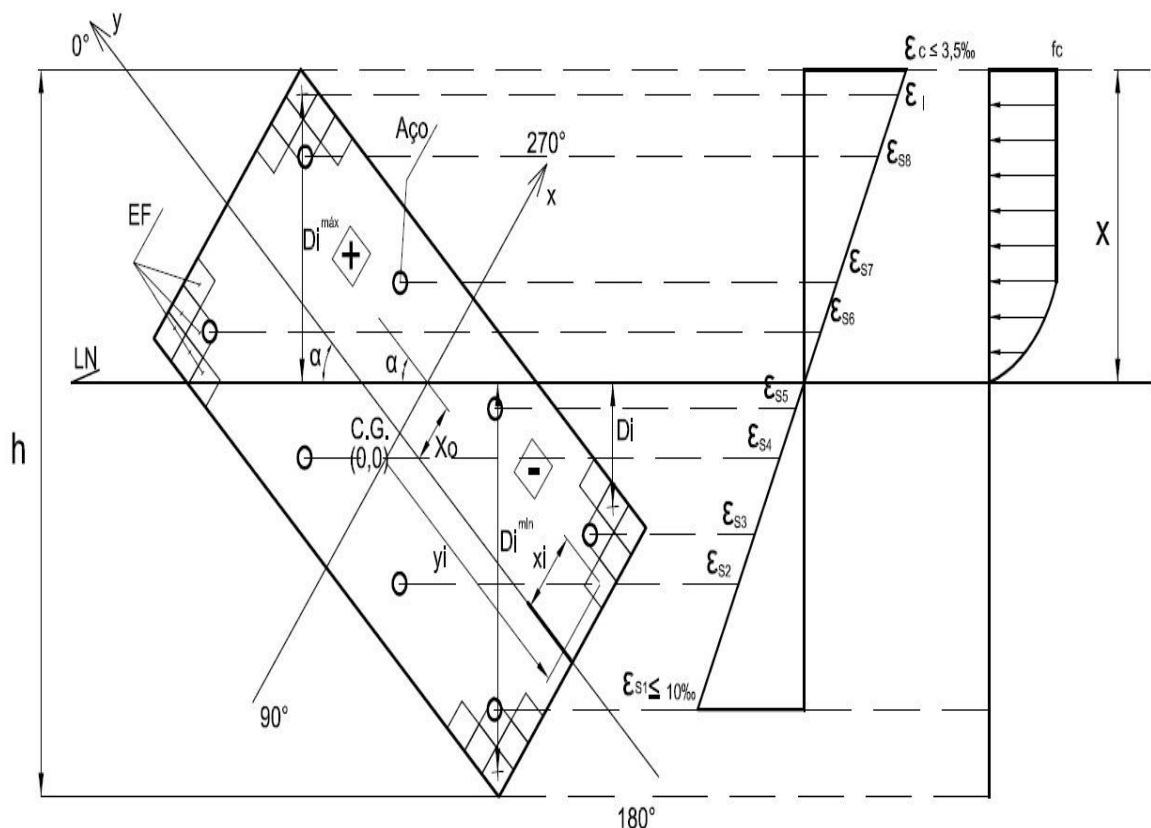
Seção de concreto armado submetida à flexão oblíqua composta, discretizada em elementos finitos de concreto e detalhada com as barras de armadura
